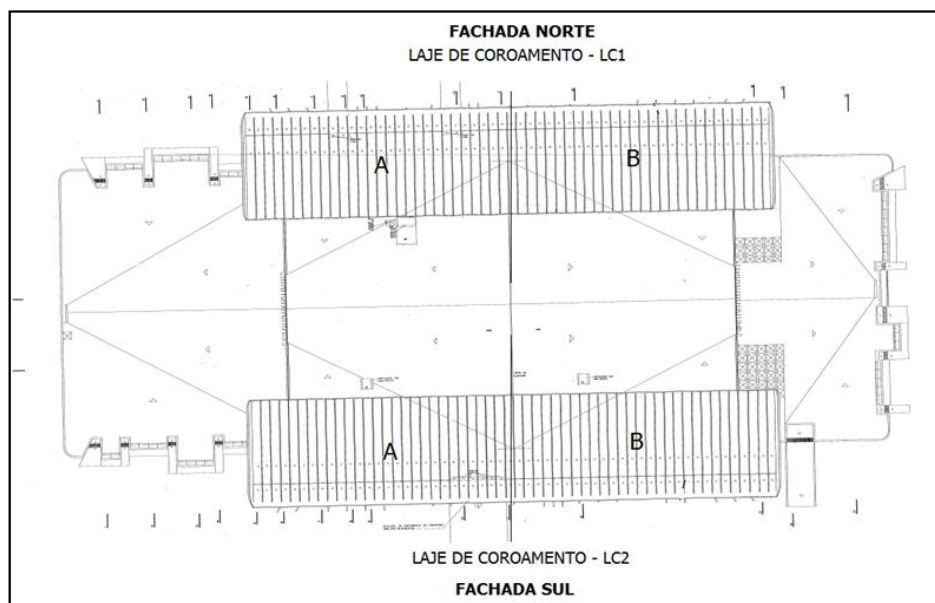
Identificação das lajes de coroamento e divisão em partes A e B.
